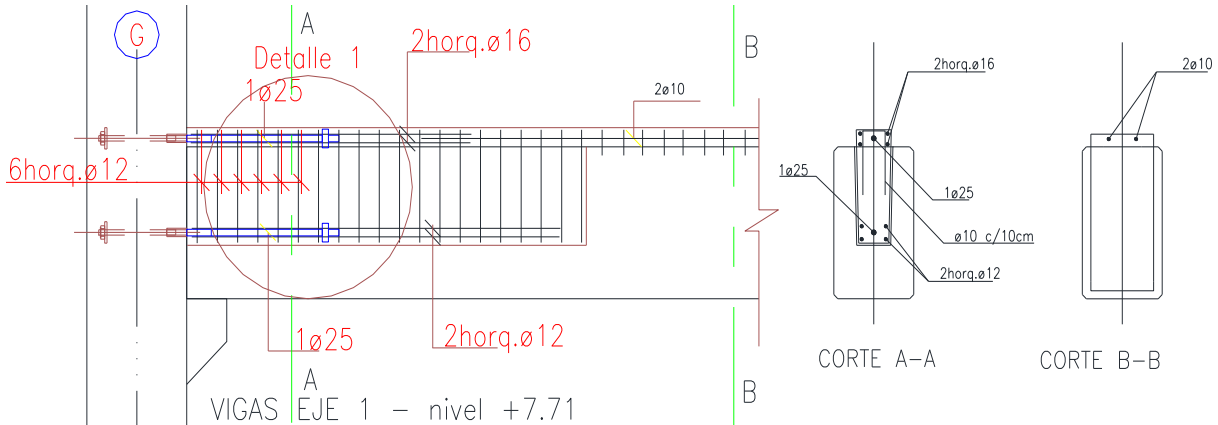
Hormigón in situ en vigas prefabricadas y panel de losa. Segundo nivel.
